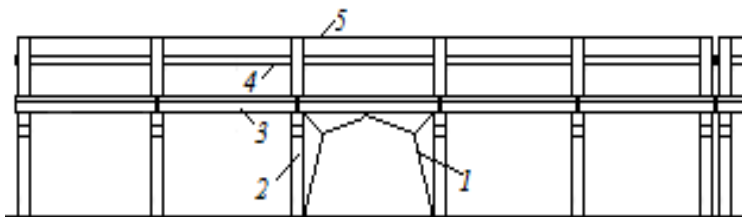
В'язі між залізобетонними колонами, встановленими з кроком 12 м: 1 – в'язі порталного типу; 2 – колони; 3 – підкранові балки; 4 – обв'язувальні балки; 5 – розпірки
